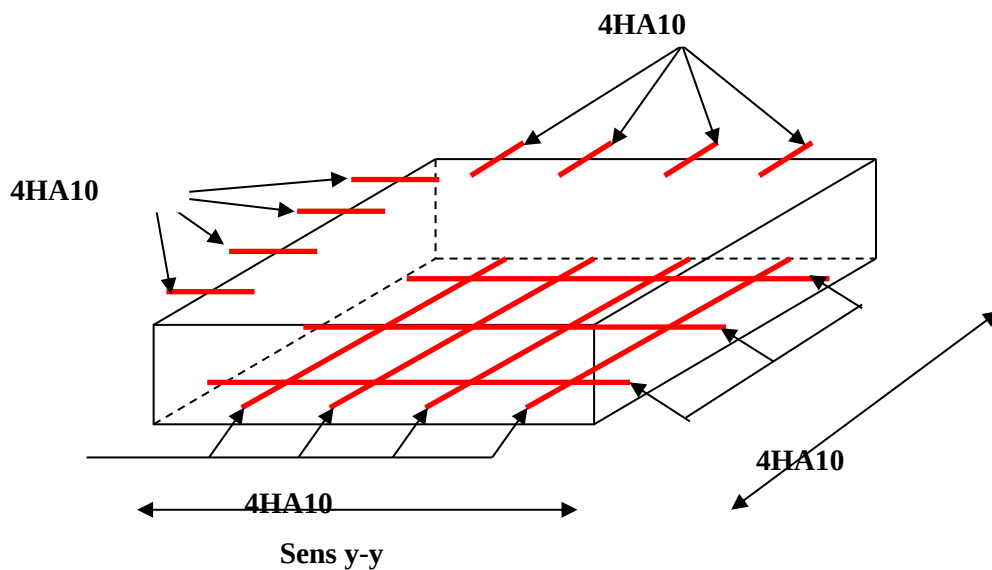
Schéma de ferrailage de la dalle pleine de la salle machine
